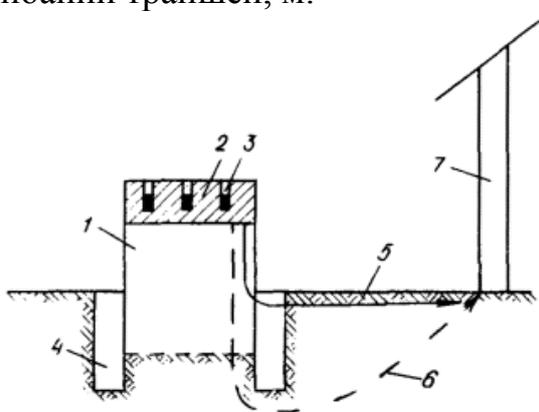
Схема окапывания разрушаемого взрывом фундамента:
